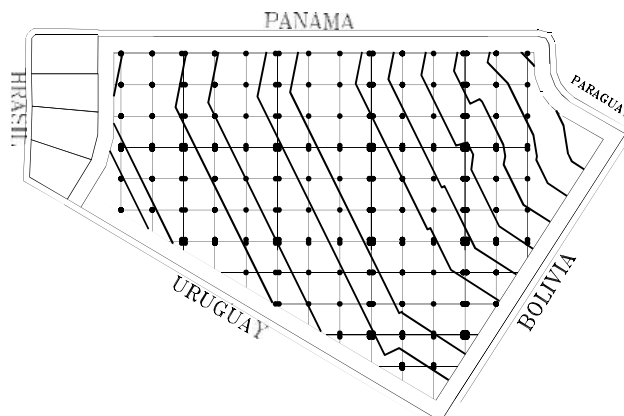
Modulación estructural para el planteamiento de la infraestructura deportiva
